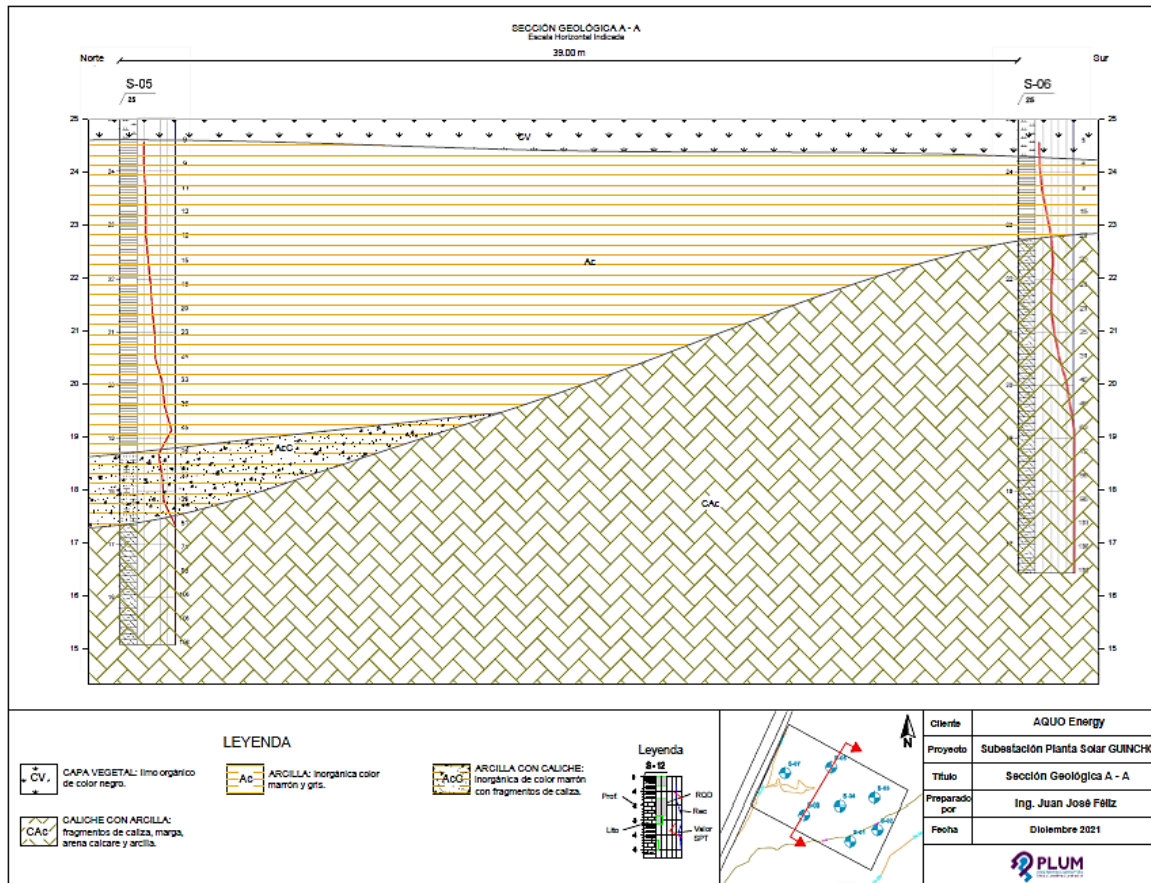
4 Estructura del suelo en el área de la subestación y edificio ETED. Fuente: Estudio geotécnico Plum Ingeniería
